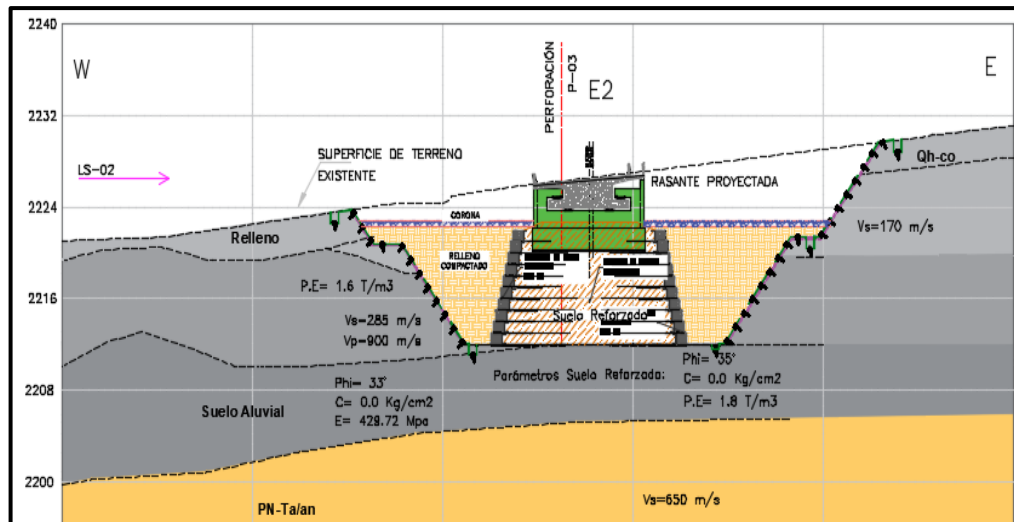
Zona de cimentación E2, con parámetros geotécnicos.
